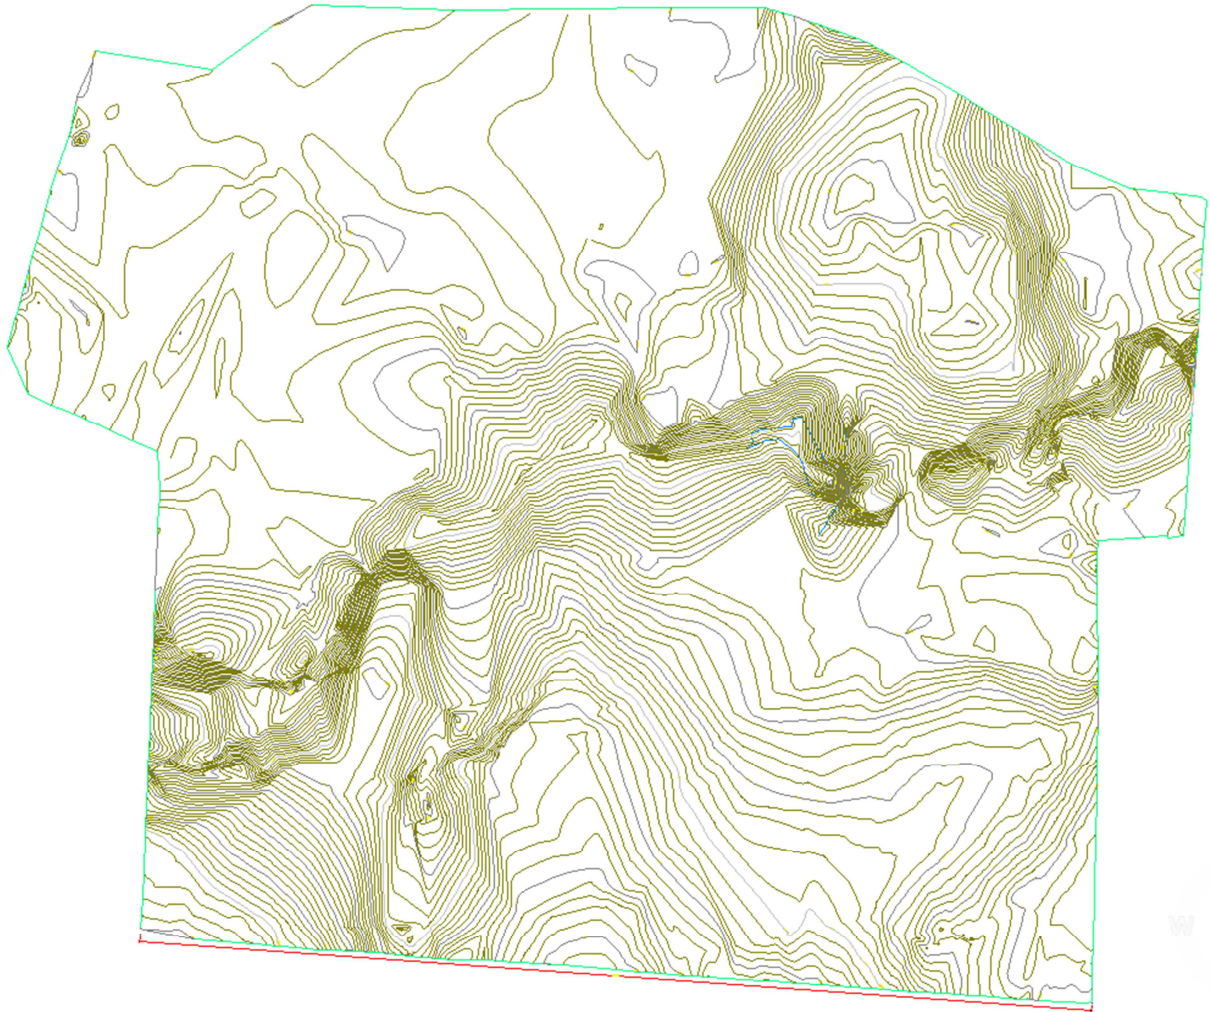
PLANIMETRIA DA ÁREA DO EMPREENDIMENTO
